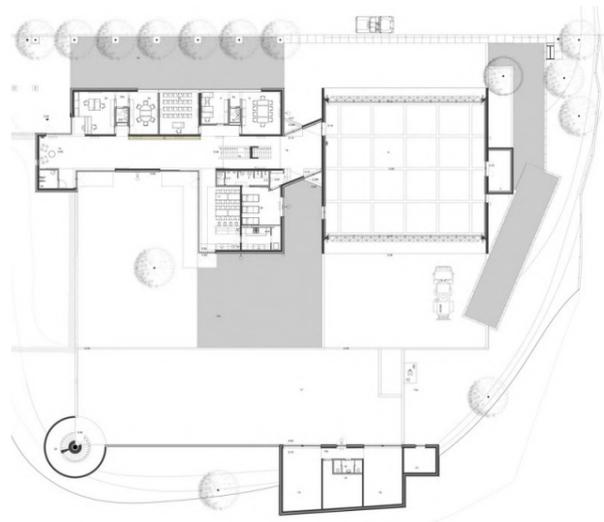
Planta arquitectónica estación de Santo Tirso. Fuente: Alvaro Siza
